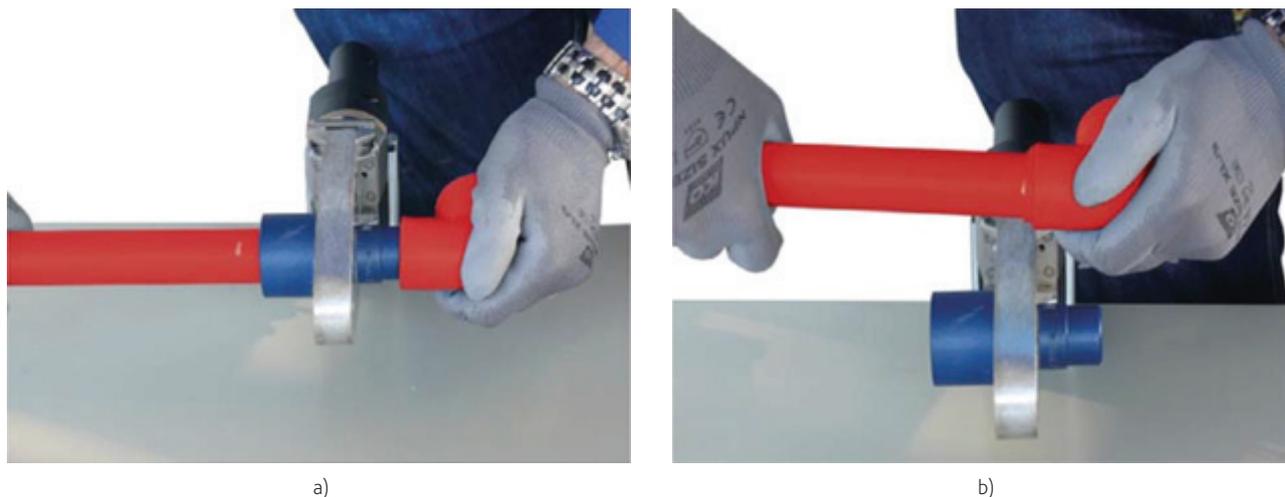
Soldadura por termofusão: a) durante a fusão; b) após a fusão
